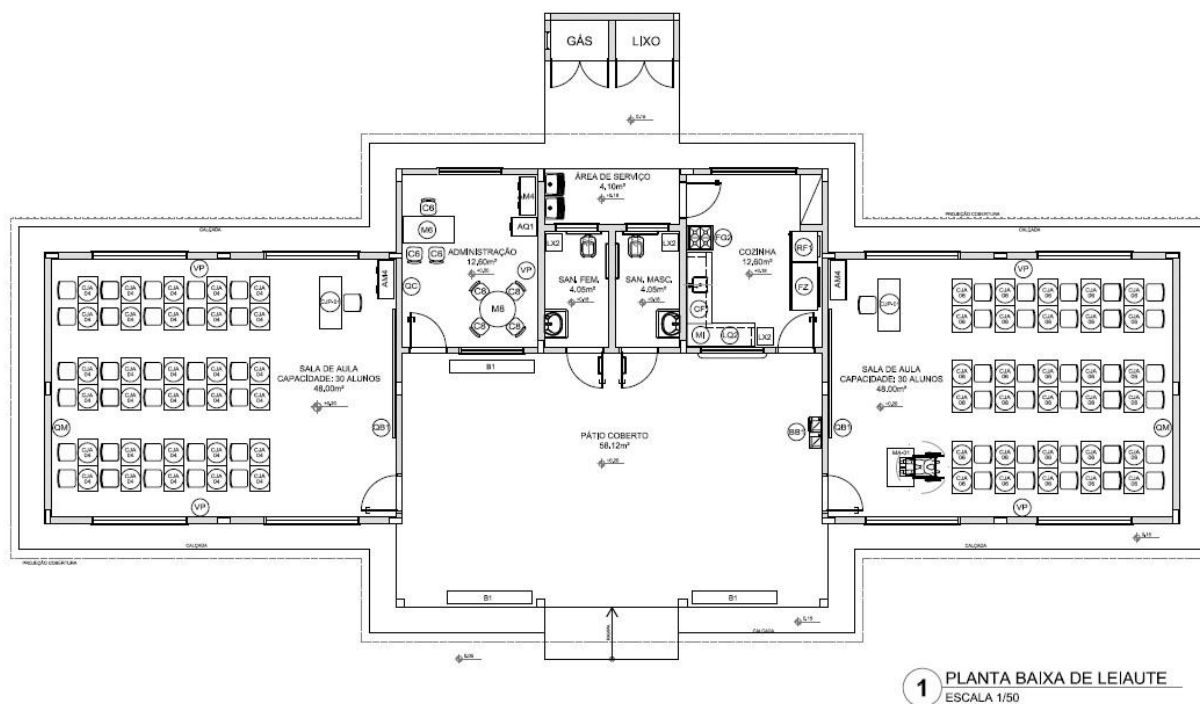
Planta Arquitetônica Fonte: projeto padrão FNDE.
